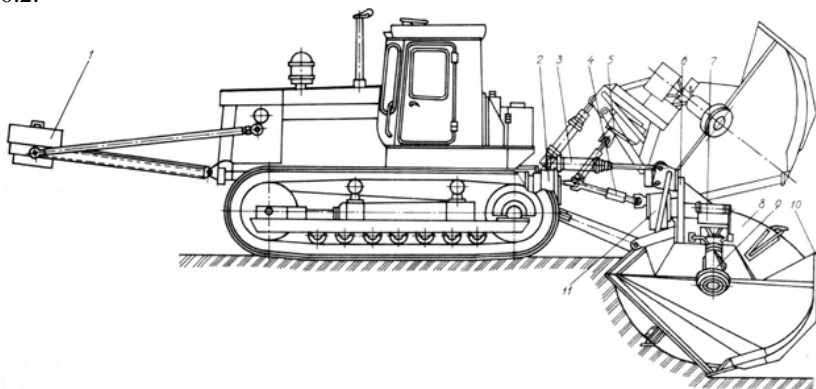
Двухфрезерный экскаватор-каналокопатель ЭТР-125А: 1 – противовес; 2 – ходоуменьшитель; 3 – гидроцилиндр подъема; 4 – карданный
